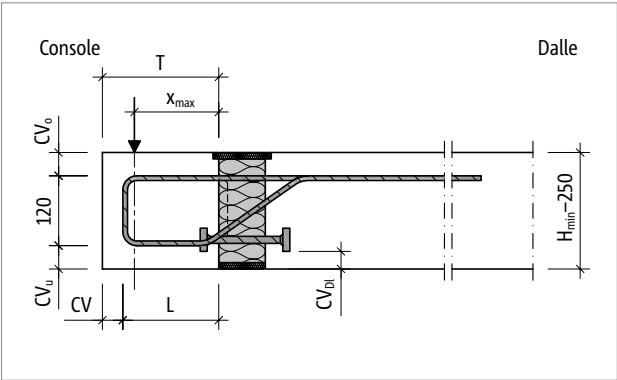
Schöck Isokorb® T type O : coupe du produit
